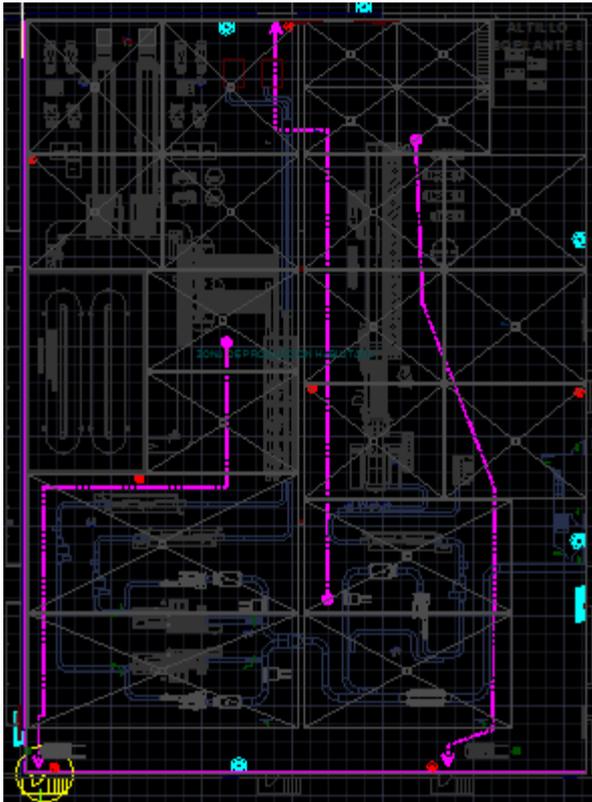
Plano en planta de recorridos de evacuación en Sala producción (Fuente propia)
